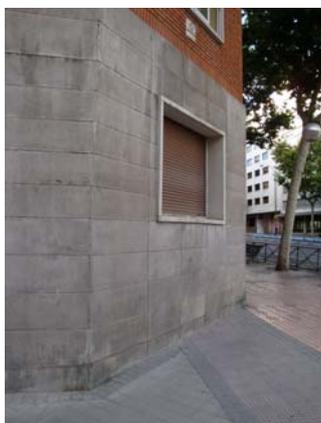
Chapado de zócalo de piedra artificial. Fig. 11. Fisuras en chapado de piedra artificial
